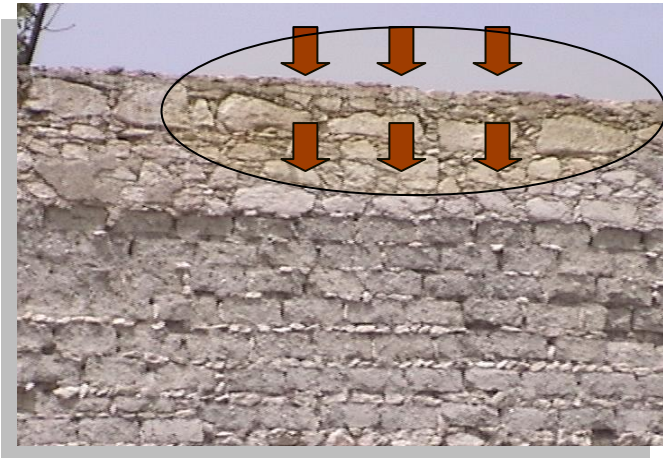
Vista del pretil de piedra sobre la crujía norte de la Hacienda del Refugio
